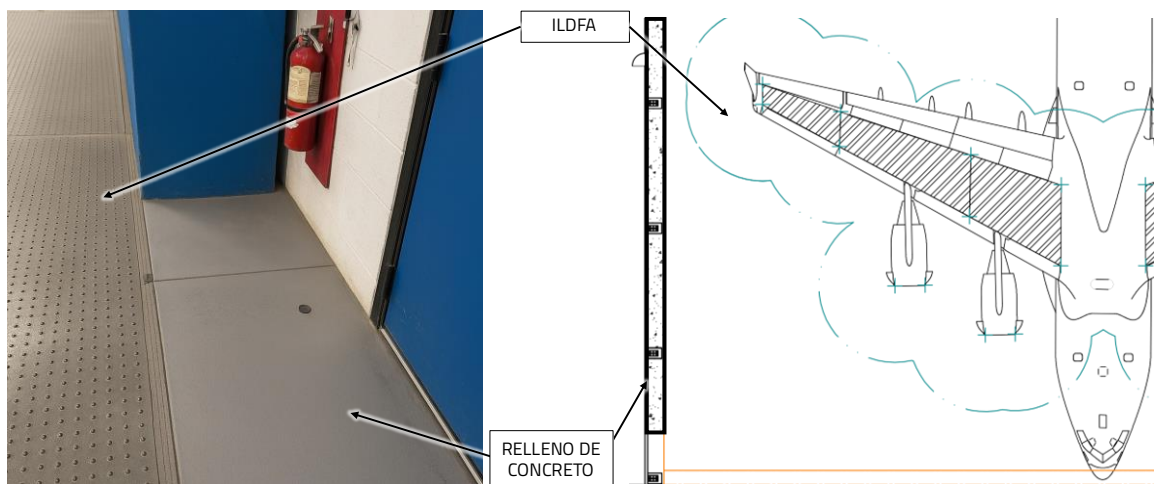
Relleno de concreto utilizado a lo largo del muro perimetral (izquierda) y planos del hangar con el relleno de concreto indicado (derecha).
